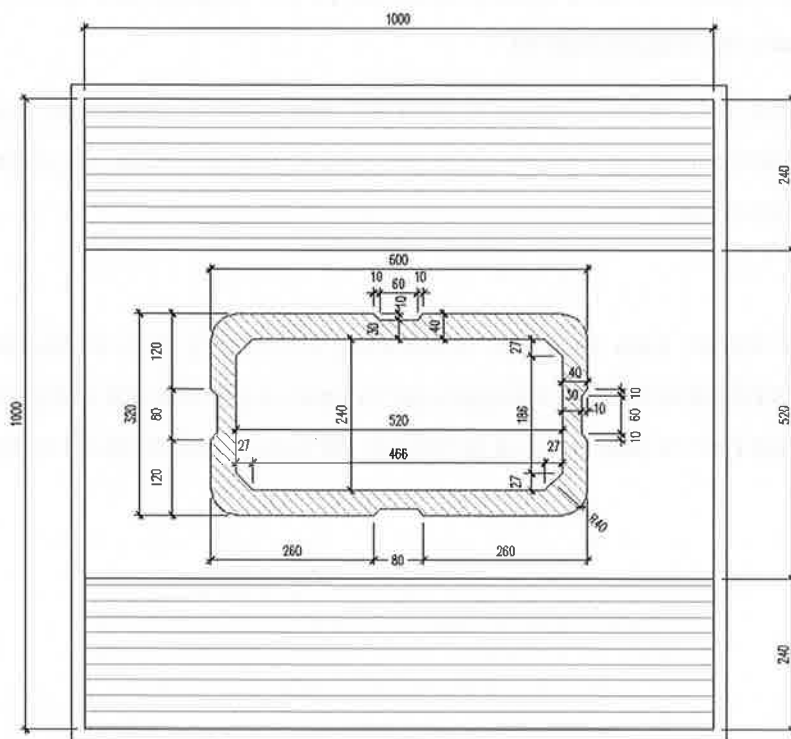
Pianta fondazioni ed elevazione pila Bonorva VI02
